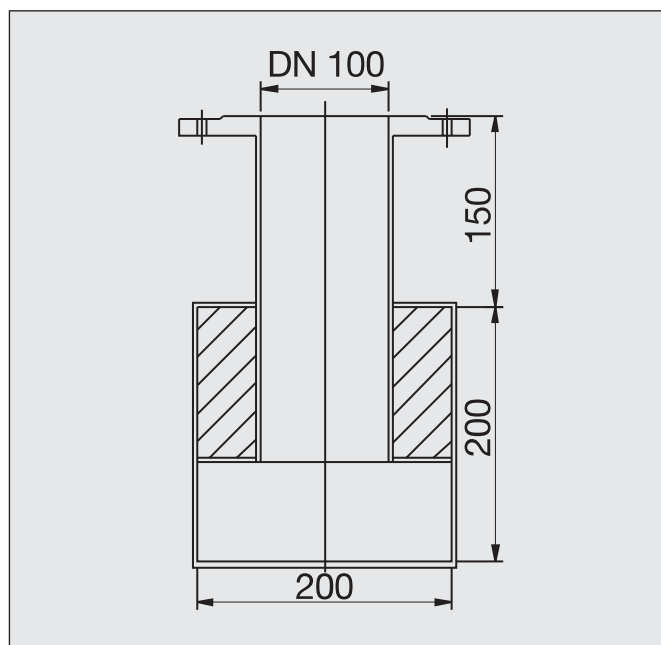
Hrdla přírub v jedné rovině, standardní délky 150mm
